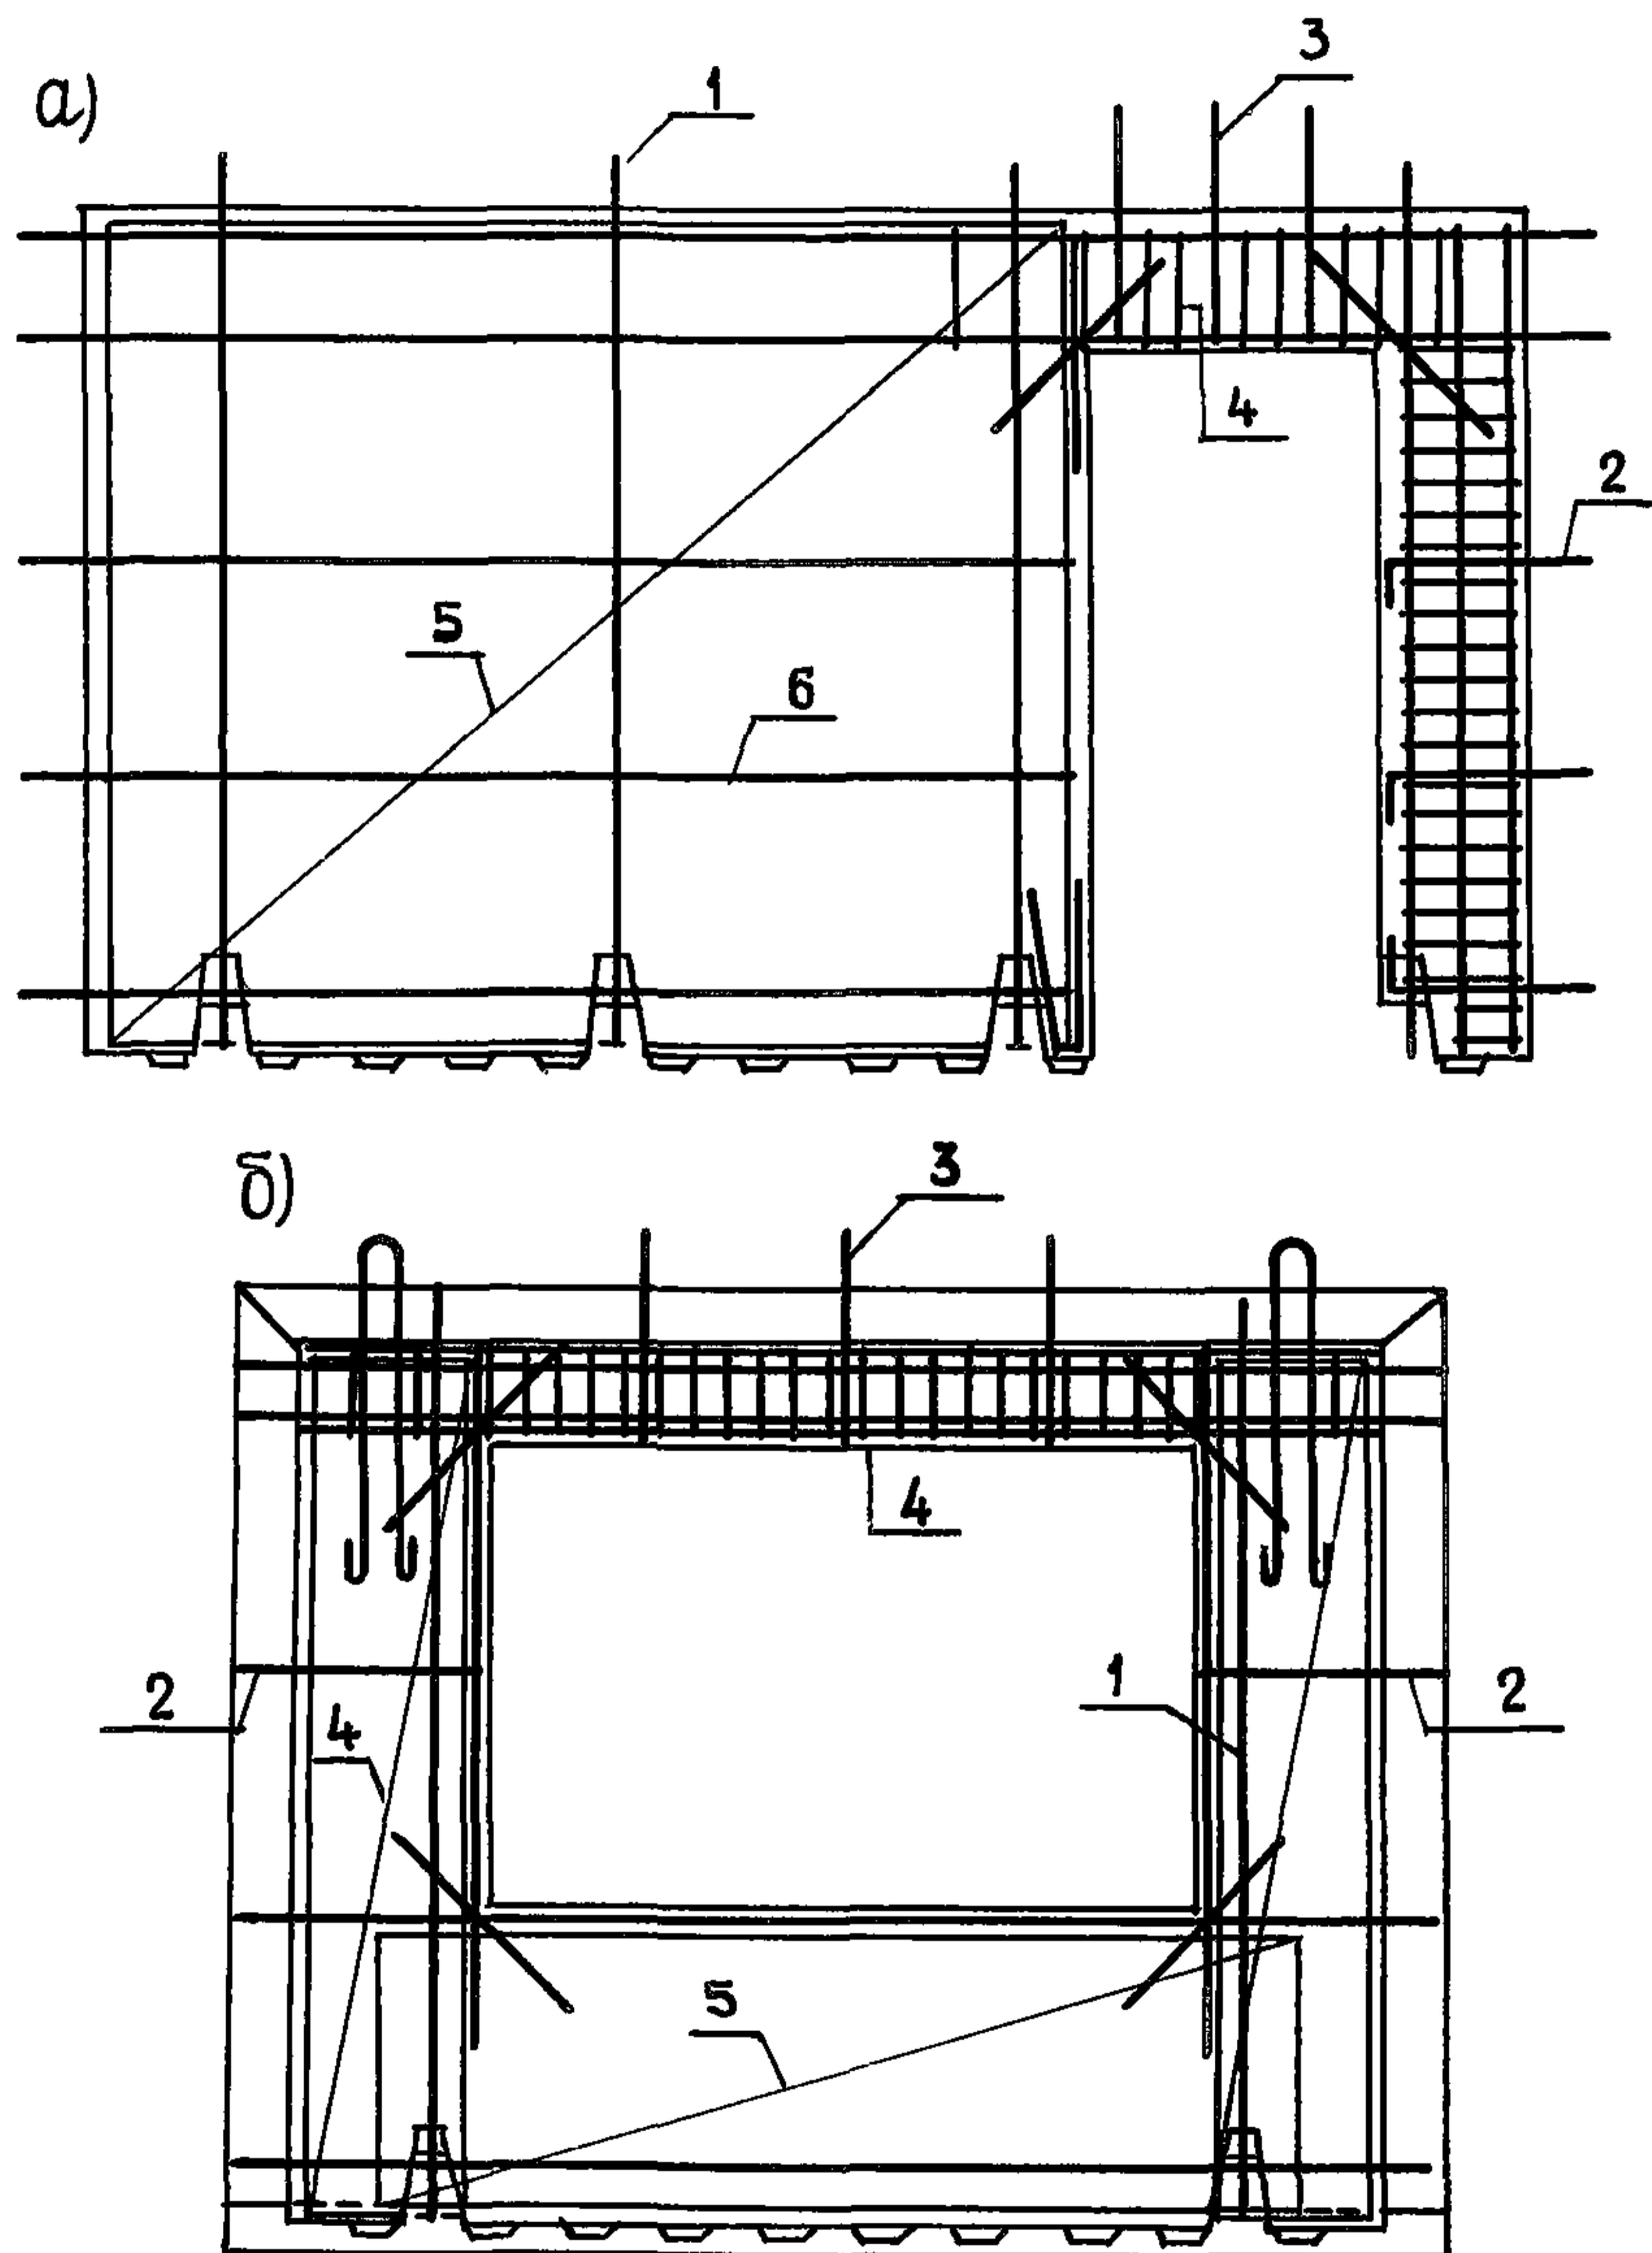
Схемы армирования стеновых панелей по опыту СРР:
